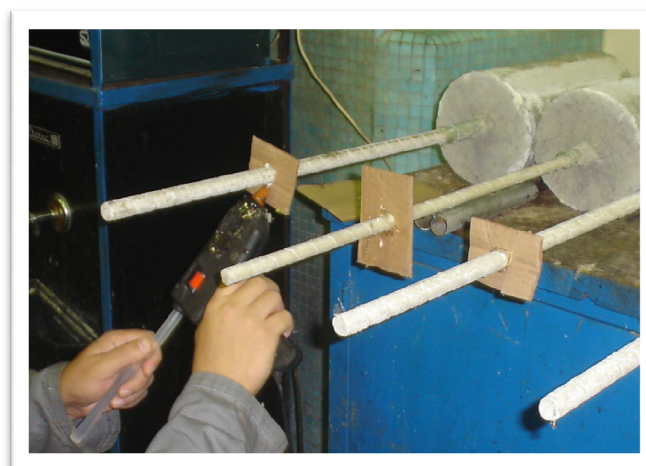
En proceso de colocación de resina epóxica, para el agarre de la máquina de ensayo.
